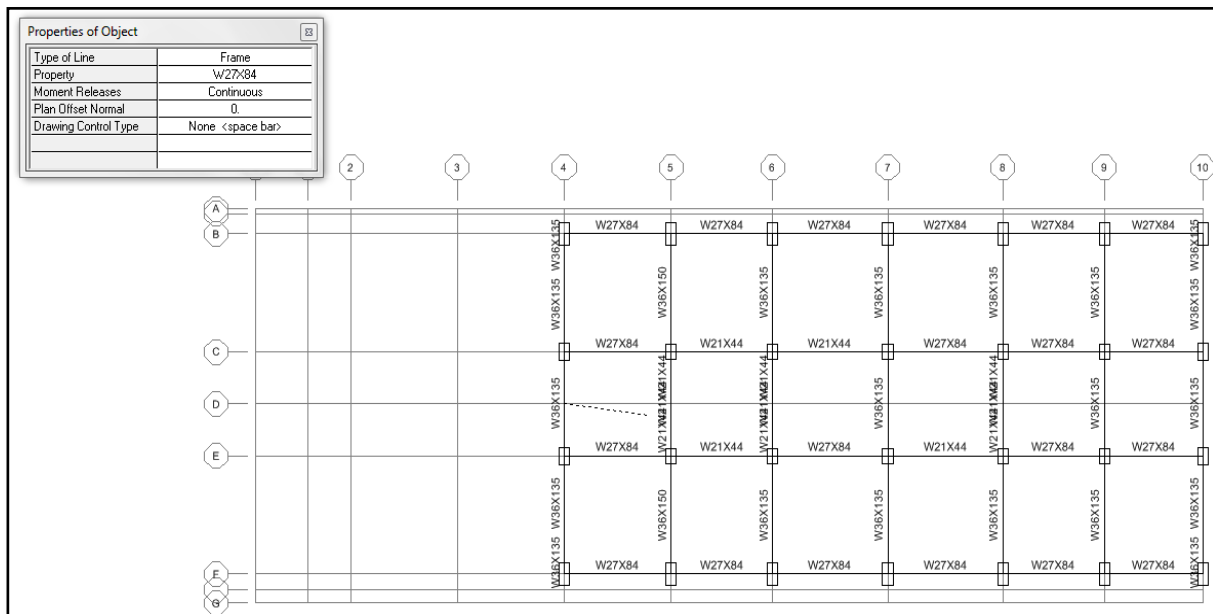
Trazo de Elementos Estructurales (Vigas Principales).
